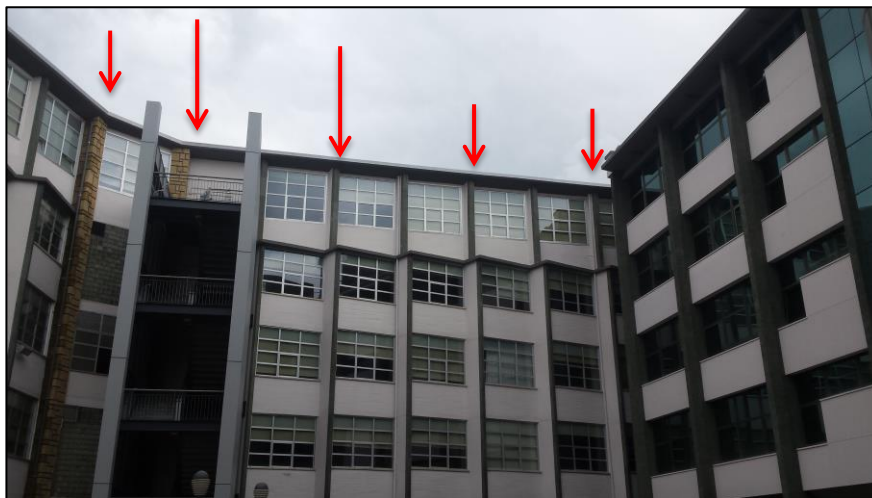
Cargas transmitidas por la cubierta a los pilares de la fachada del edificio A en sus apoyos
